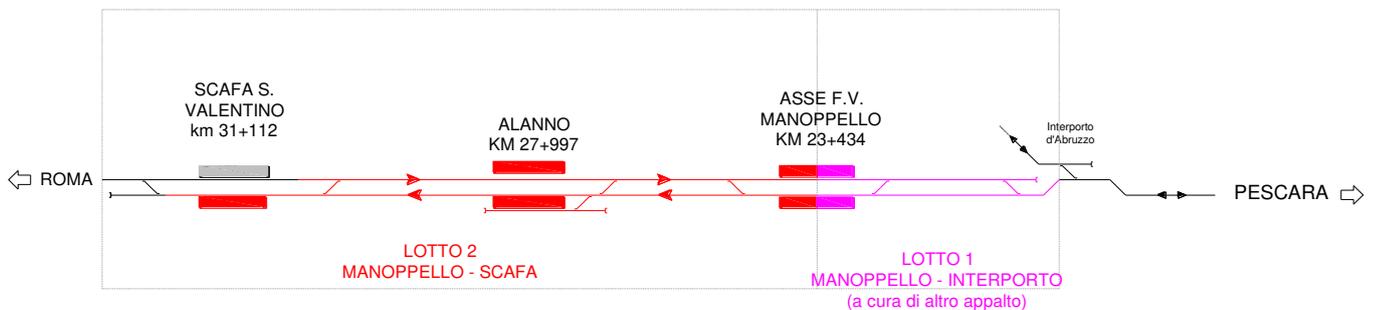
Layout di progetto raddoppio completo Lotto 1 (a cura di altro appalto) e Lotto 2
